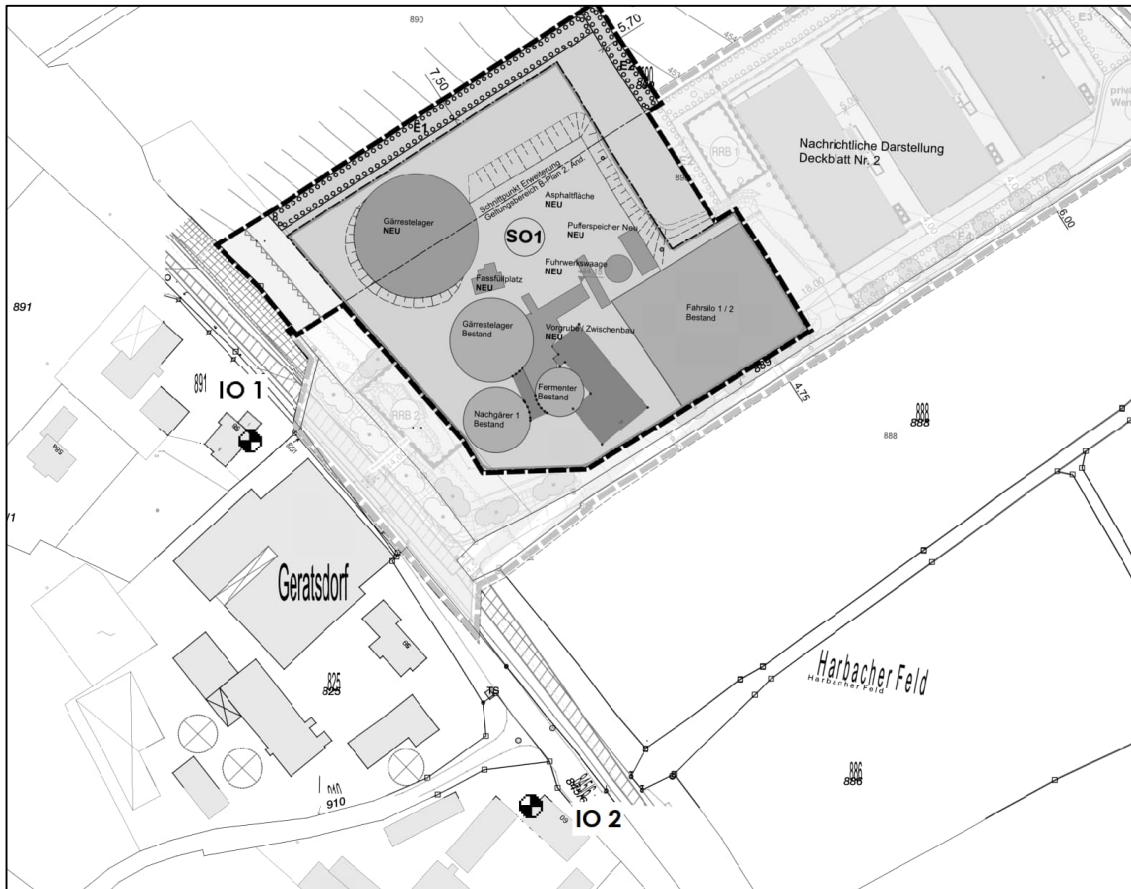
Lageplan mit Darstellung der Immissionsorte (IO)
